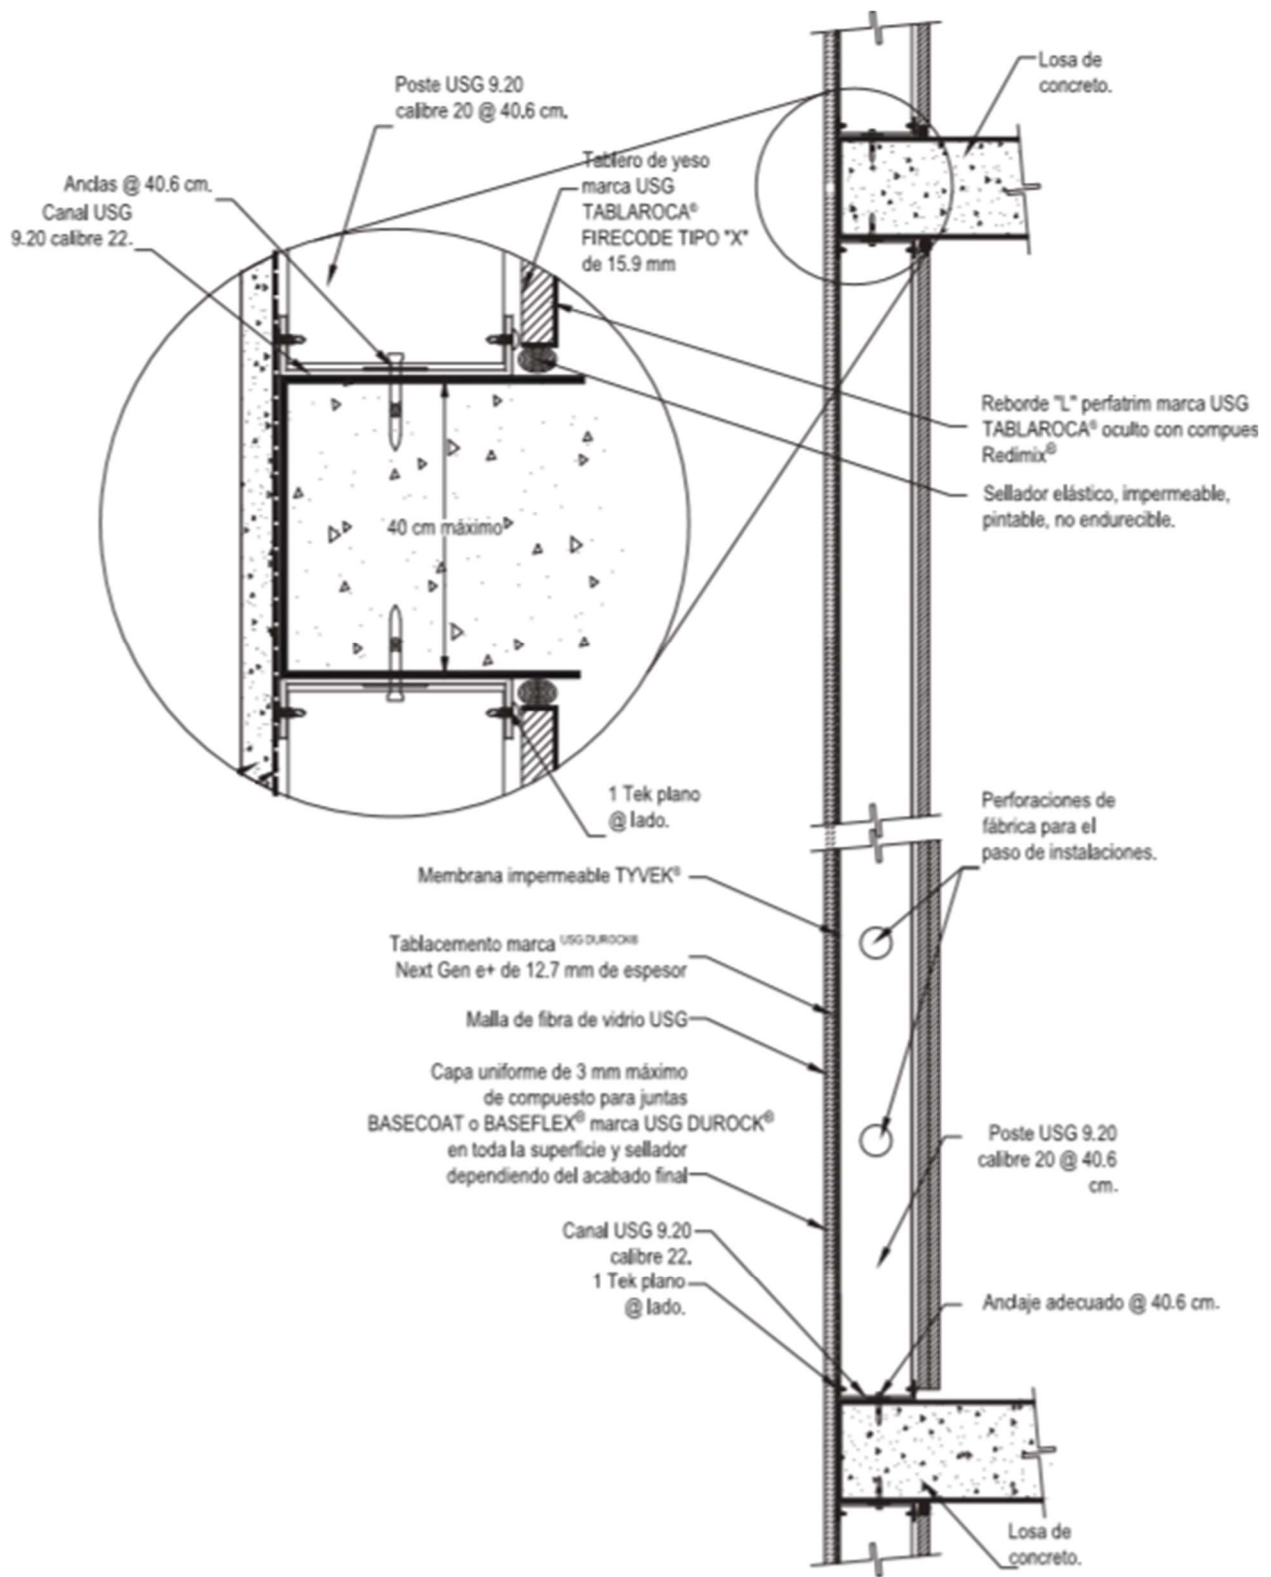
Instalación Losa a Losa - USG, 2016.
